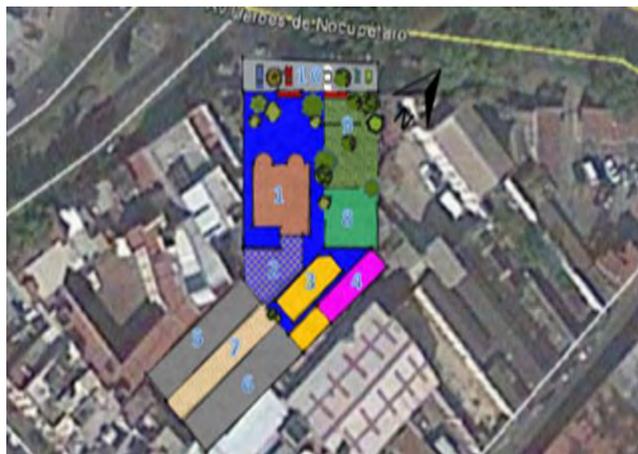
Croquis de la Planta Arquitectónica, Edición VAM
